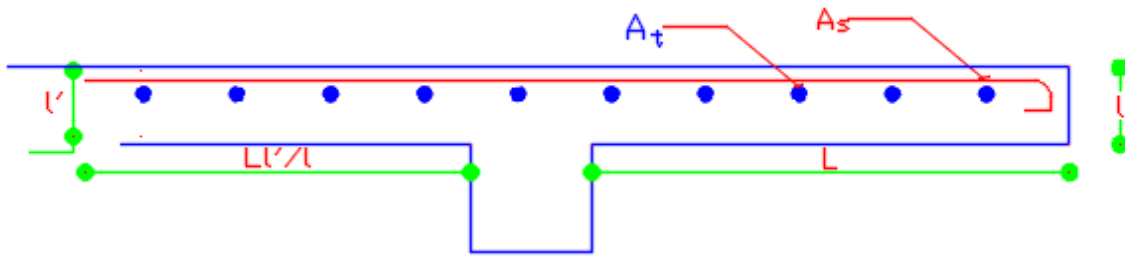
FERRAILAGE D'UNE DALLE EN PORTE-A-FAUX
